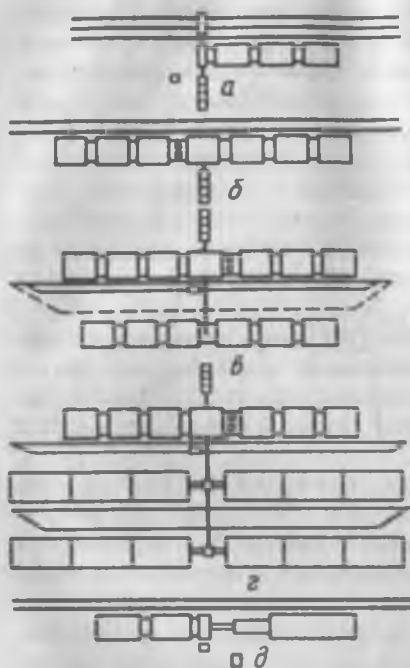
Схемы компоновки рабочего здания и силосных корпусов:
